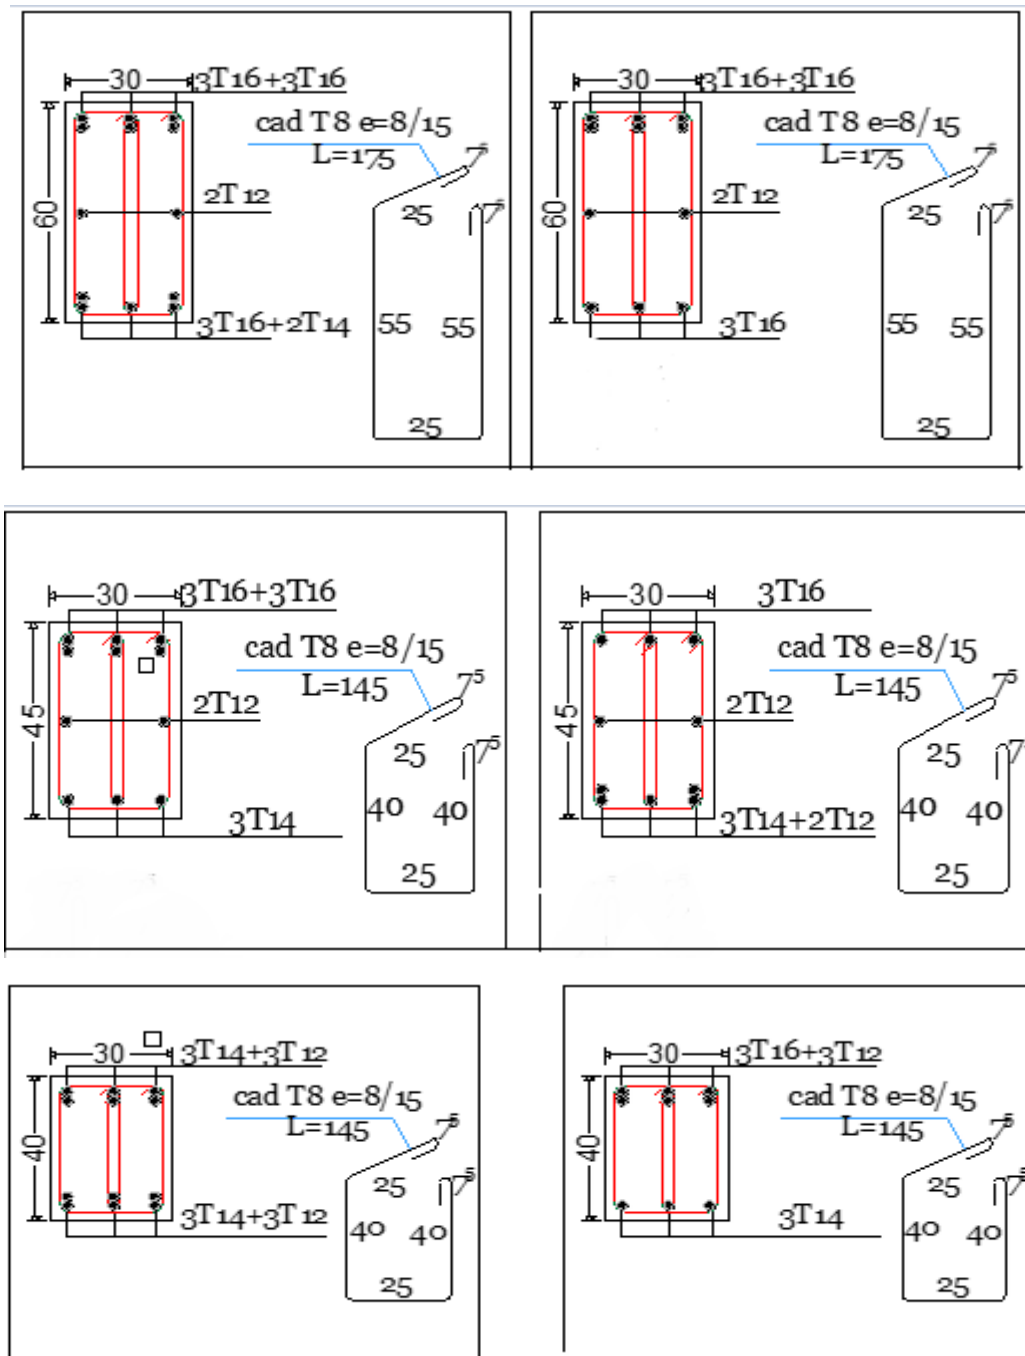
Coupe de ferrailage des poutres secondaires au niveau d'appuis et travée.
